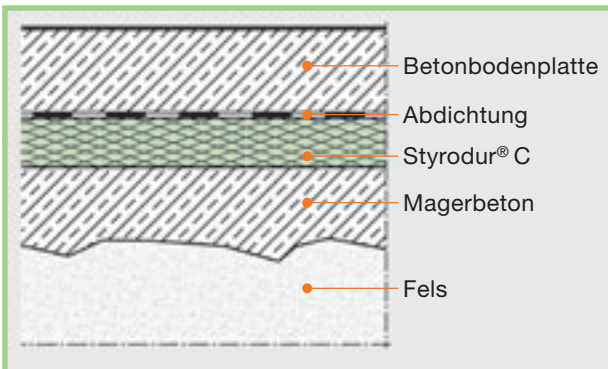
Ausgleichsschicht aus Magerbeton bei Baugrund Fels.
